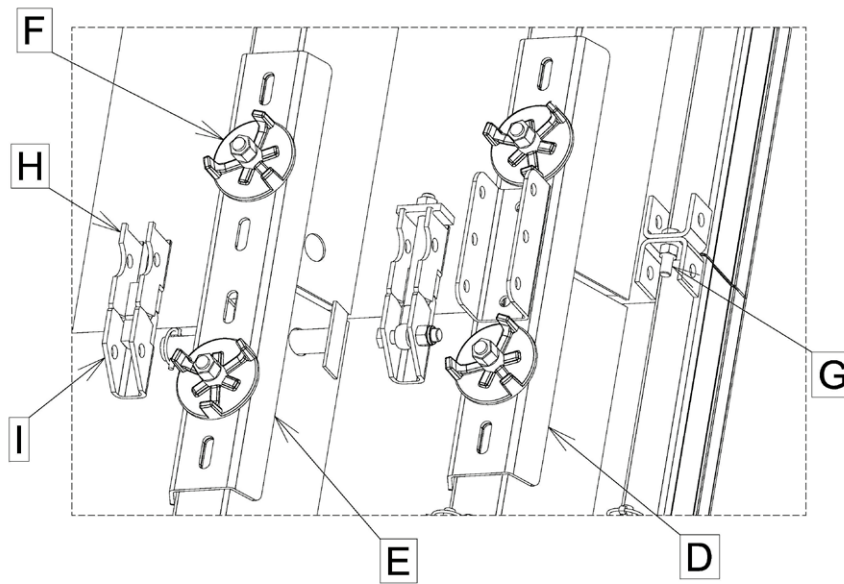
Détail A zoom sur les accessoires nécessaires à la superposition
